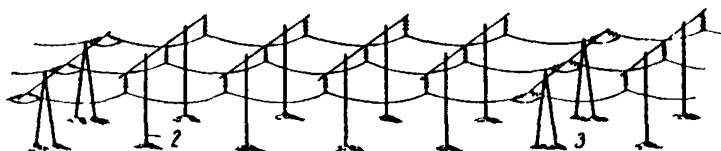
Схема подвески проводов ЛЭП на анкерных и промежуточных деревянных опорах:
